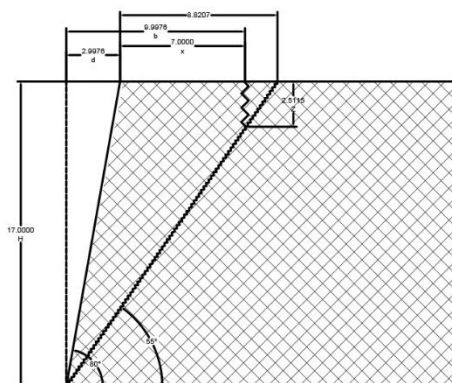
SCHEMA PENDIO CON TENSION CRACK
